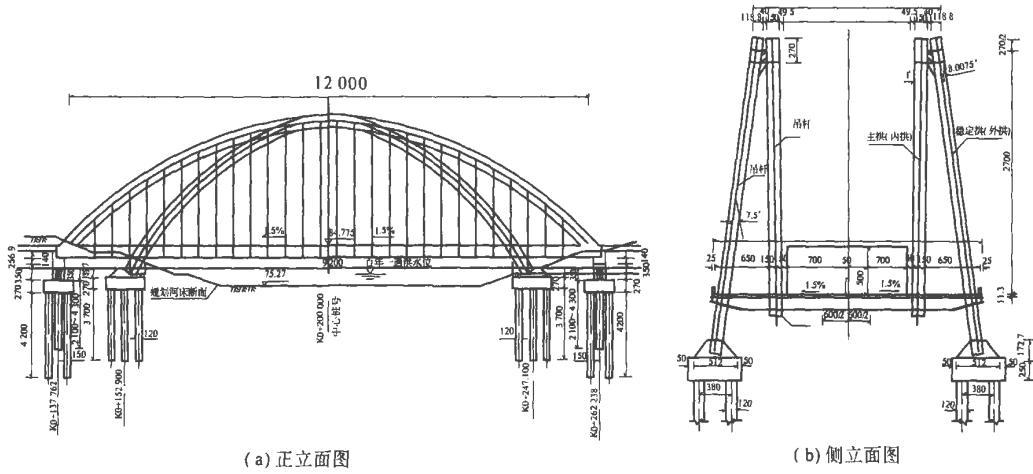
主桥正立面及侧立面布置图(除标高外单位为 cm)
